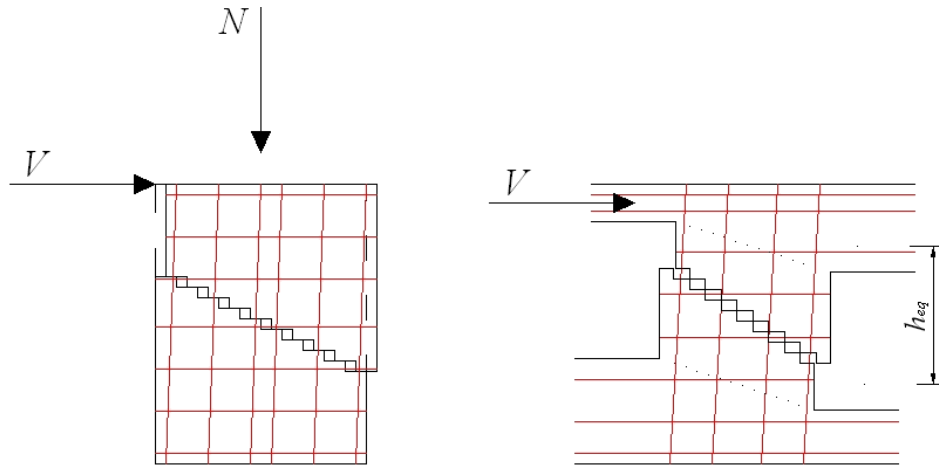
Meccanismo di rottura per taglio-scorrimento
